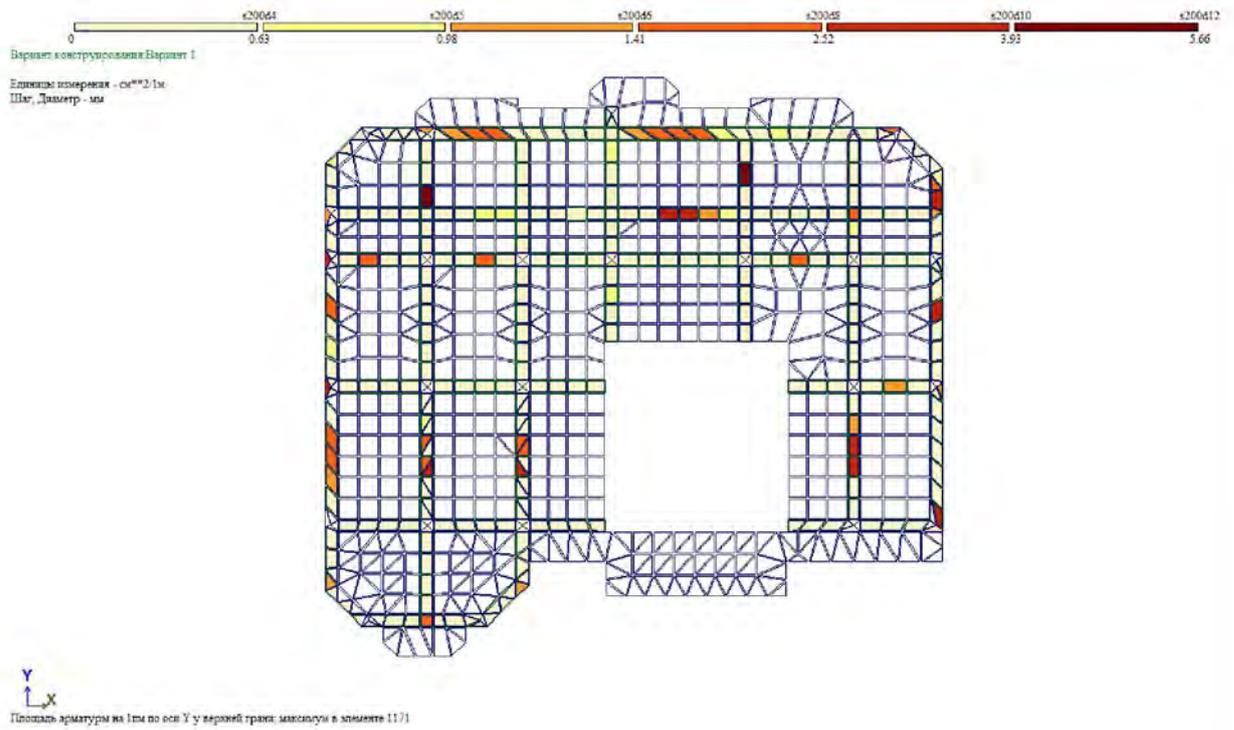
Площадь армирования по оси Y у верхней грани в ребрах.
